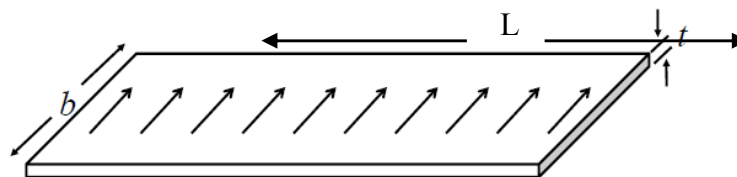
Diafragma horizontal y carga en dirección horizontal
